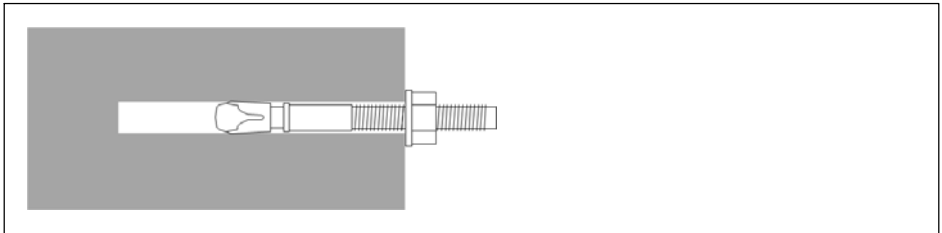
Serrage de l'écrou pour ouvrir et immobiliser l'ancrage
